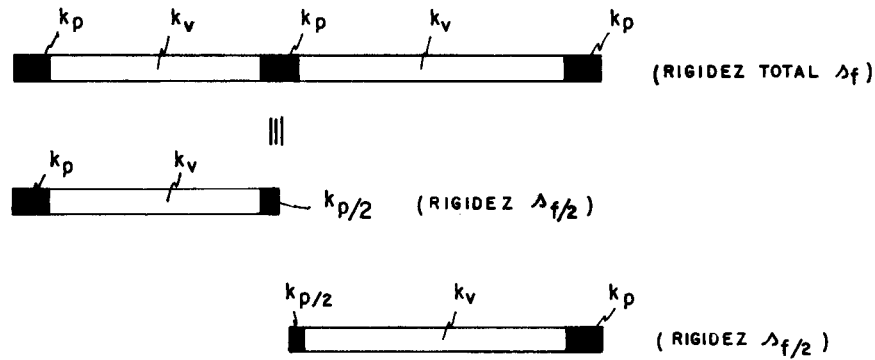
SEPARAÇÃO DOS PÓRTICOS
